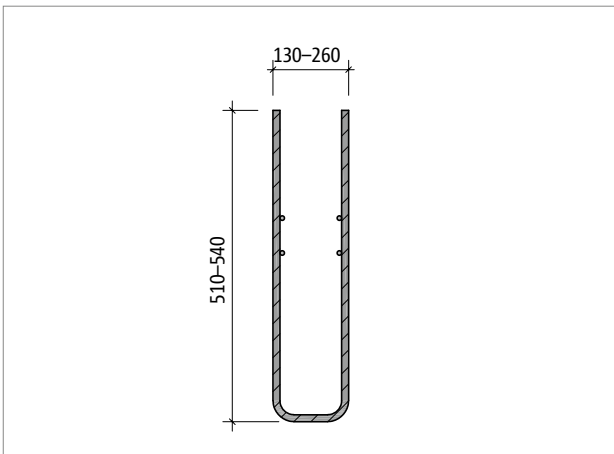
Schöck Sconnex® Typ W Part TB: Zulagebewehrung 3 \varnothing 12/65 mm; Bügel als Spaltzugbewehrung
